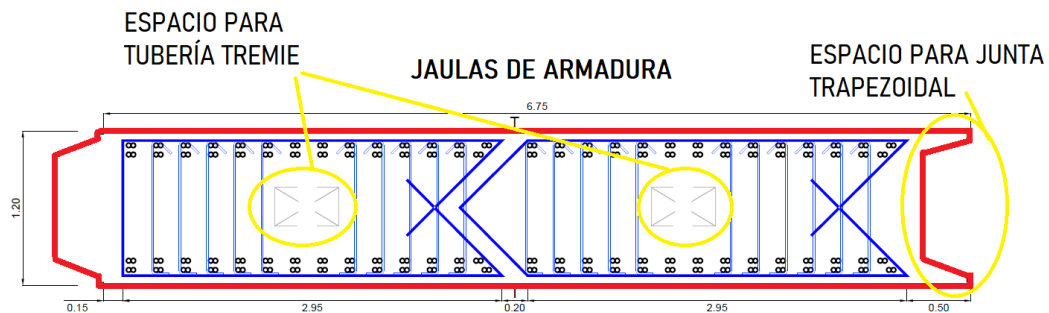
Sección transversal de jaulas de acero en panel.
